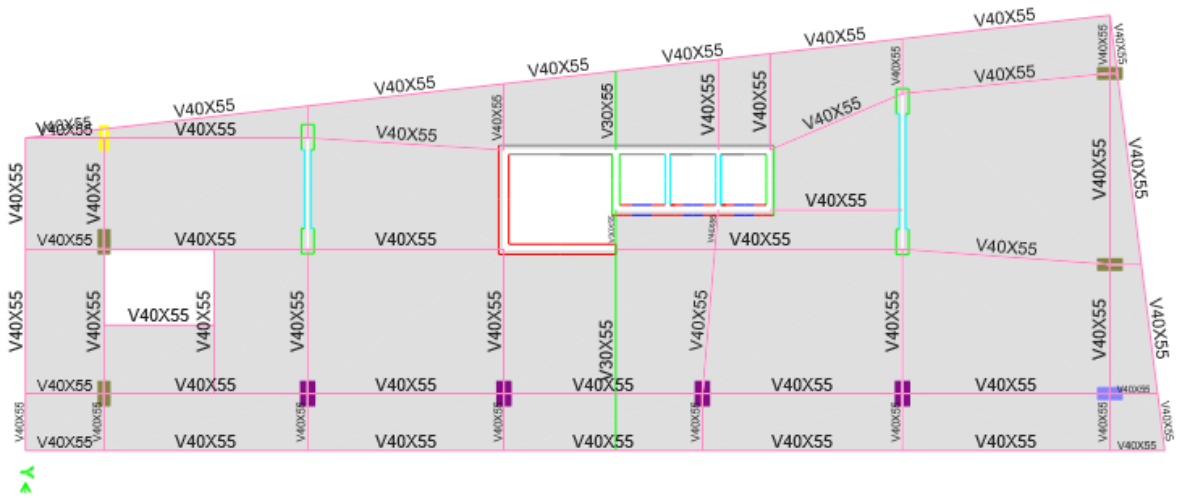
Planta Tipo N+5.20 a N+27.88
